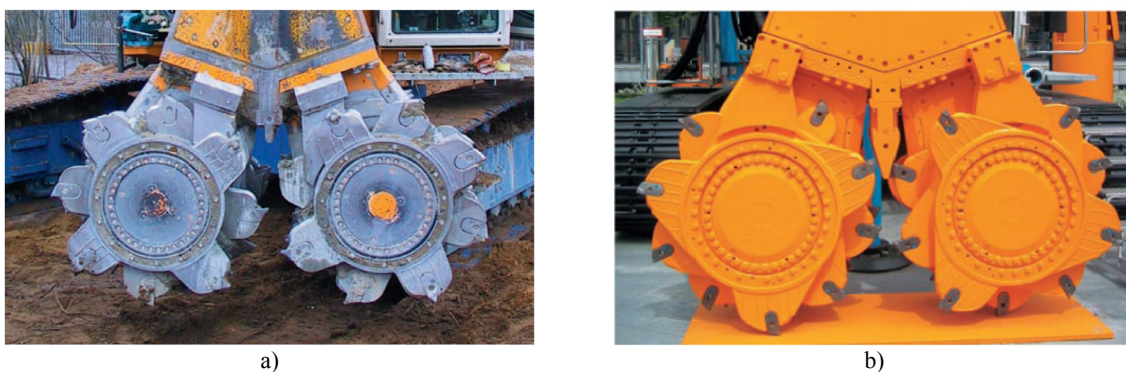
Tipos de rodas de corte: a) tipo 3-1; b) tipo 3-2 (Bauer, 2010)
